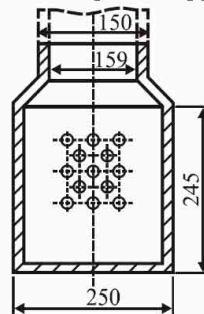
Приемная стальная сварная сетка
